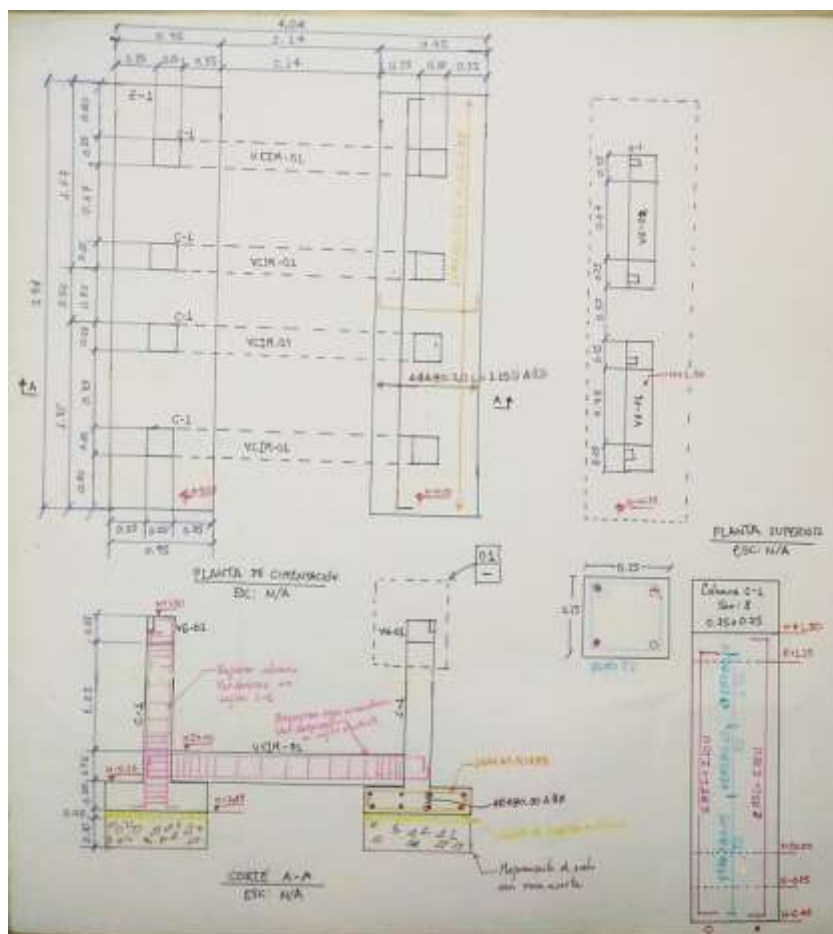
Planos piernas de aspiración. Fuente. FERVAR INGENIEROS E.U.
